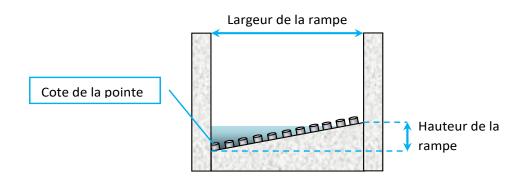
Coupe type d'une rampe rugueuse à anguilles
